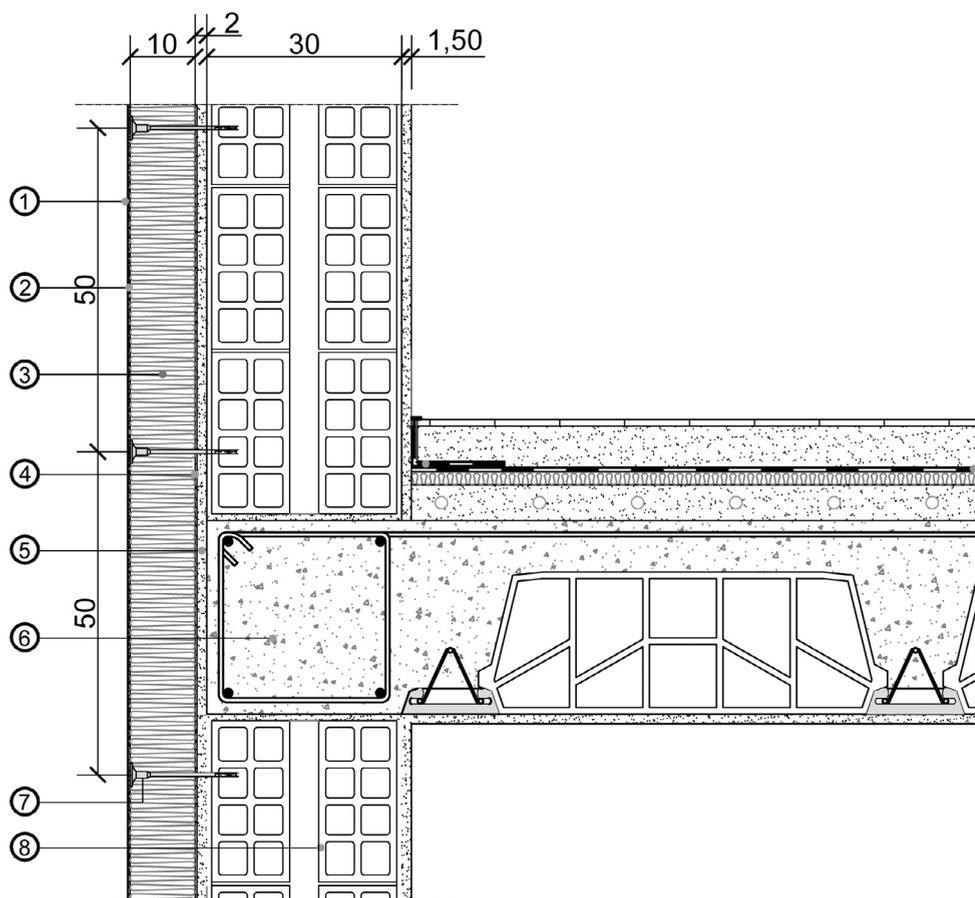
Dettaglio tecnico in sezione verticale di soluzione di isolamento a cappotto ETICS.
